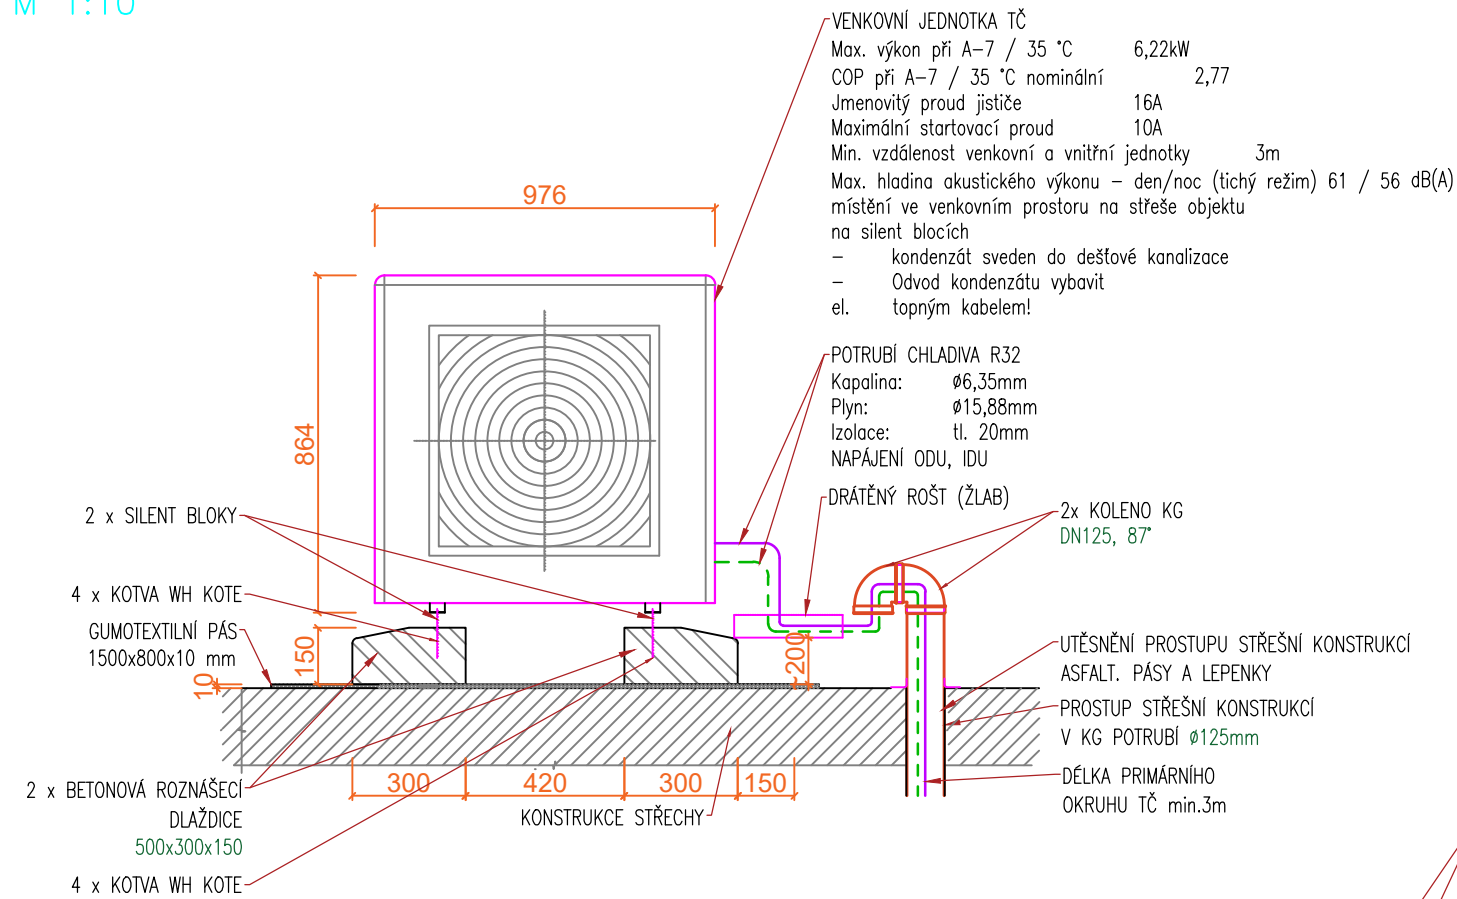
## DETAIL VENKOVNÍ JEDNOTKA – POHLED
